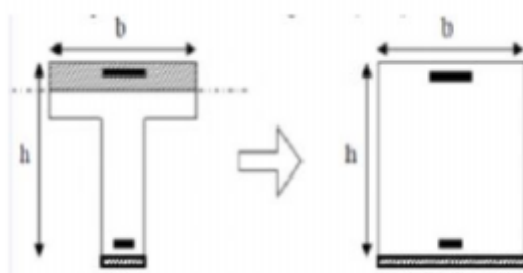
Section en T d'une poutre en béton armée renforcée en flexion par CFRP
